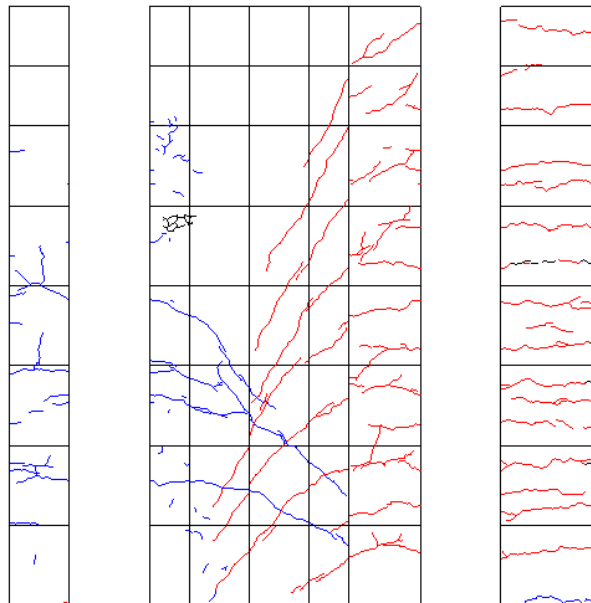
R=1/67 ひび割れ図
